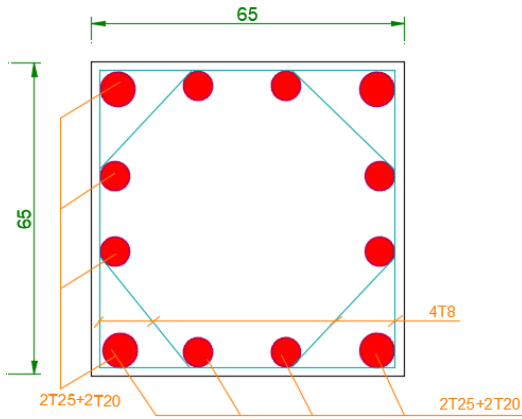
Schéma De Ferrailage Des Poteaux de 3^{eme} et 4^{eme} étages.
